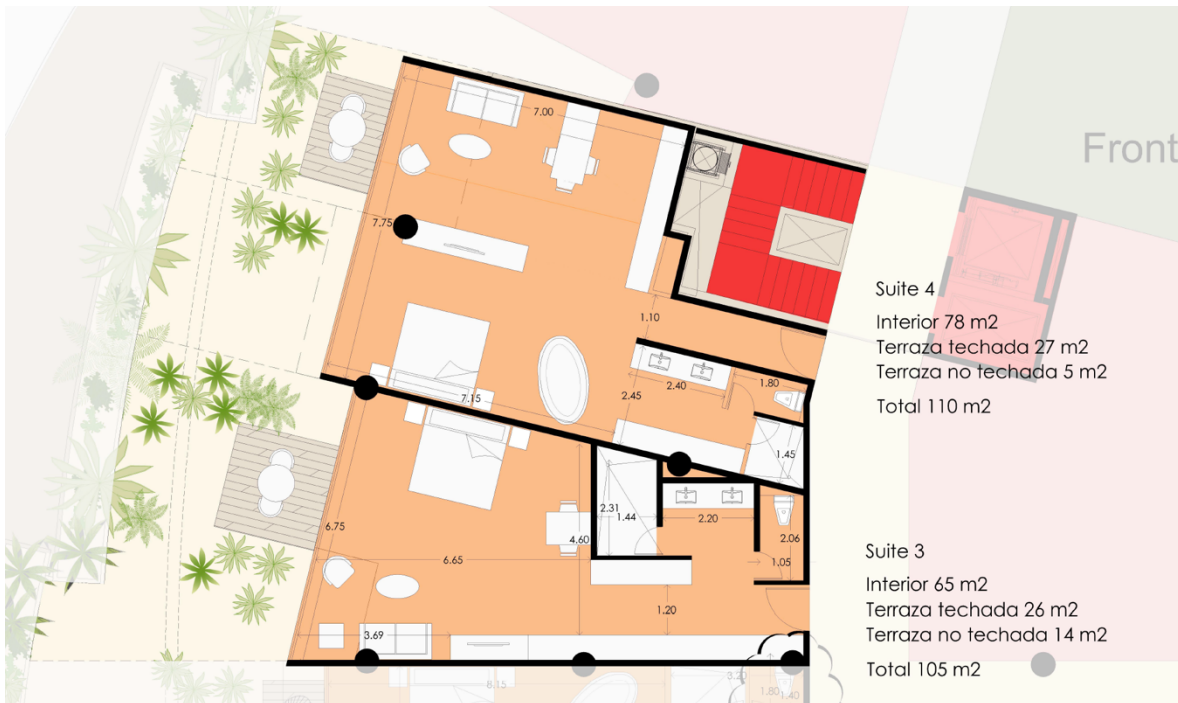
DEPARTAMENTOS SUITE 3 Y 4 DE PLANTA BAJA
